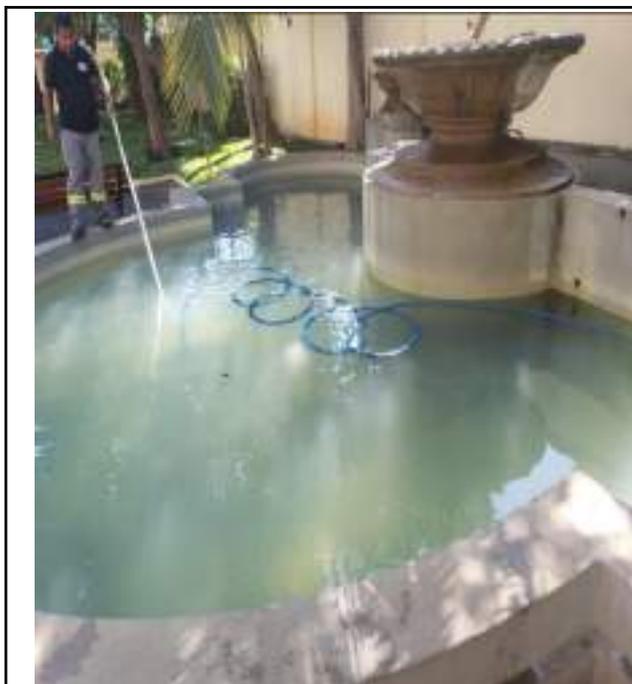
Conservação dos elementos construtivos do chafariz externo (Ajuste dos parâmetros da água, para recirculação).
